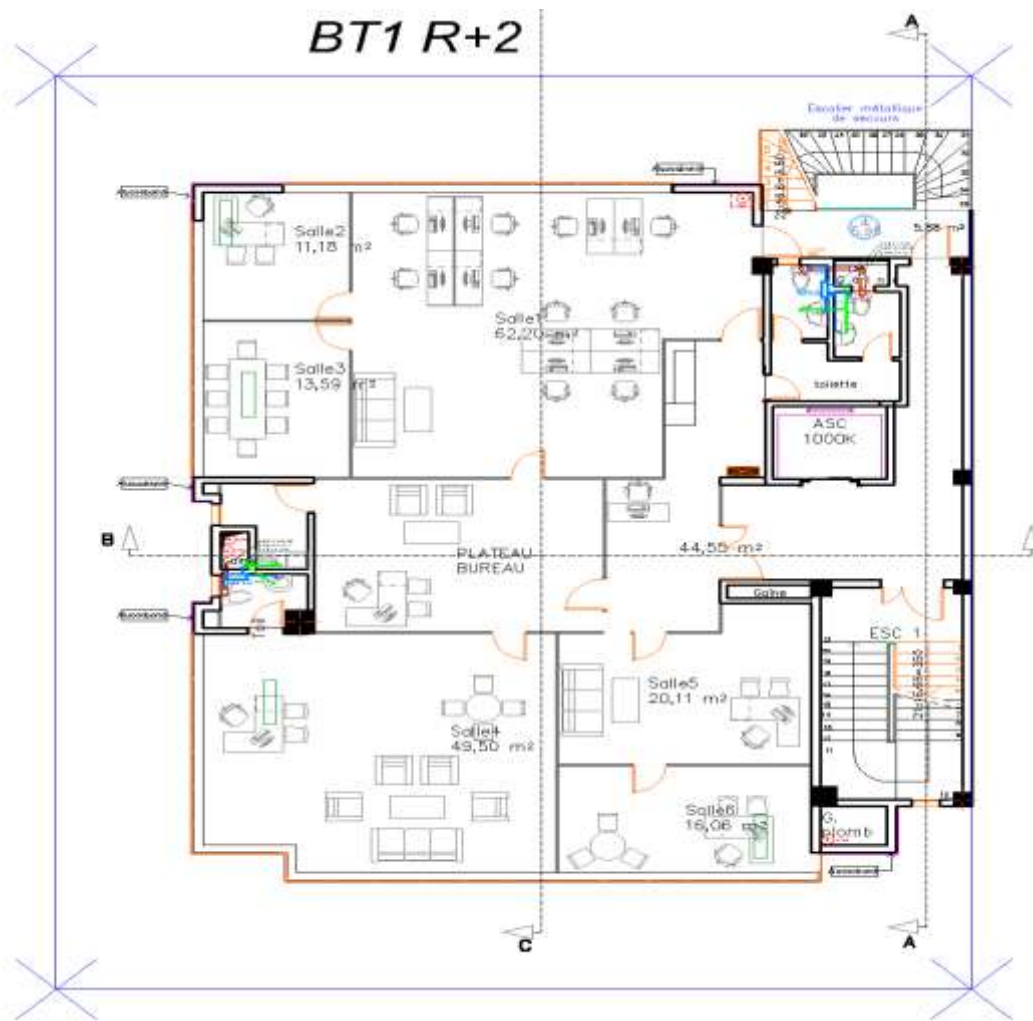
Plan du Bâtiment Tertiaire 1 niveau R+2
